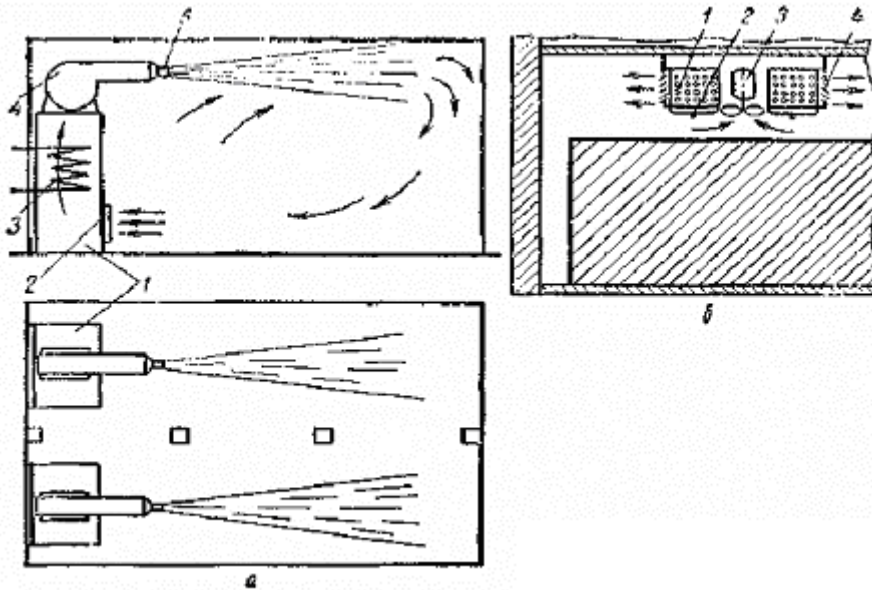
Безканальна система розподілу повітря: а – з постаментними охолоджувачами повітря; 1 – постаментний охолоджувач повітря; 2 – всмоктувальне вікно; 3 – охолоджувальні секції; 4 – відцентровий вентилятор; 5 – сопло; б – з підвісними охолоджувачами повітря; 1 – підвісний охолоджувач повітря; 2 – піддон розподілювача повітря; 3 – вентилятор; 4 – апарат, що направляє. Стрілки показують напрям руху повітря
